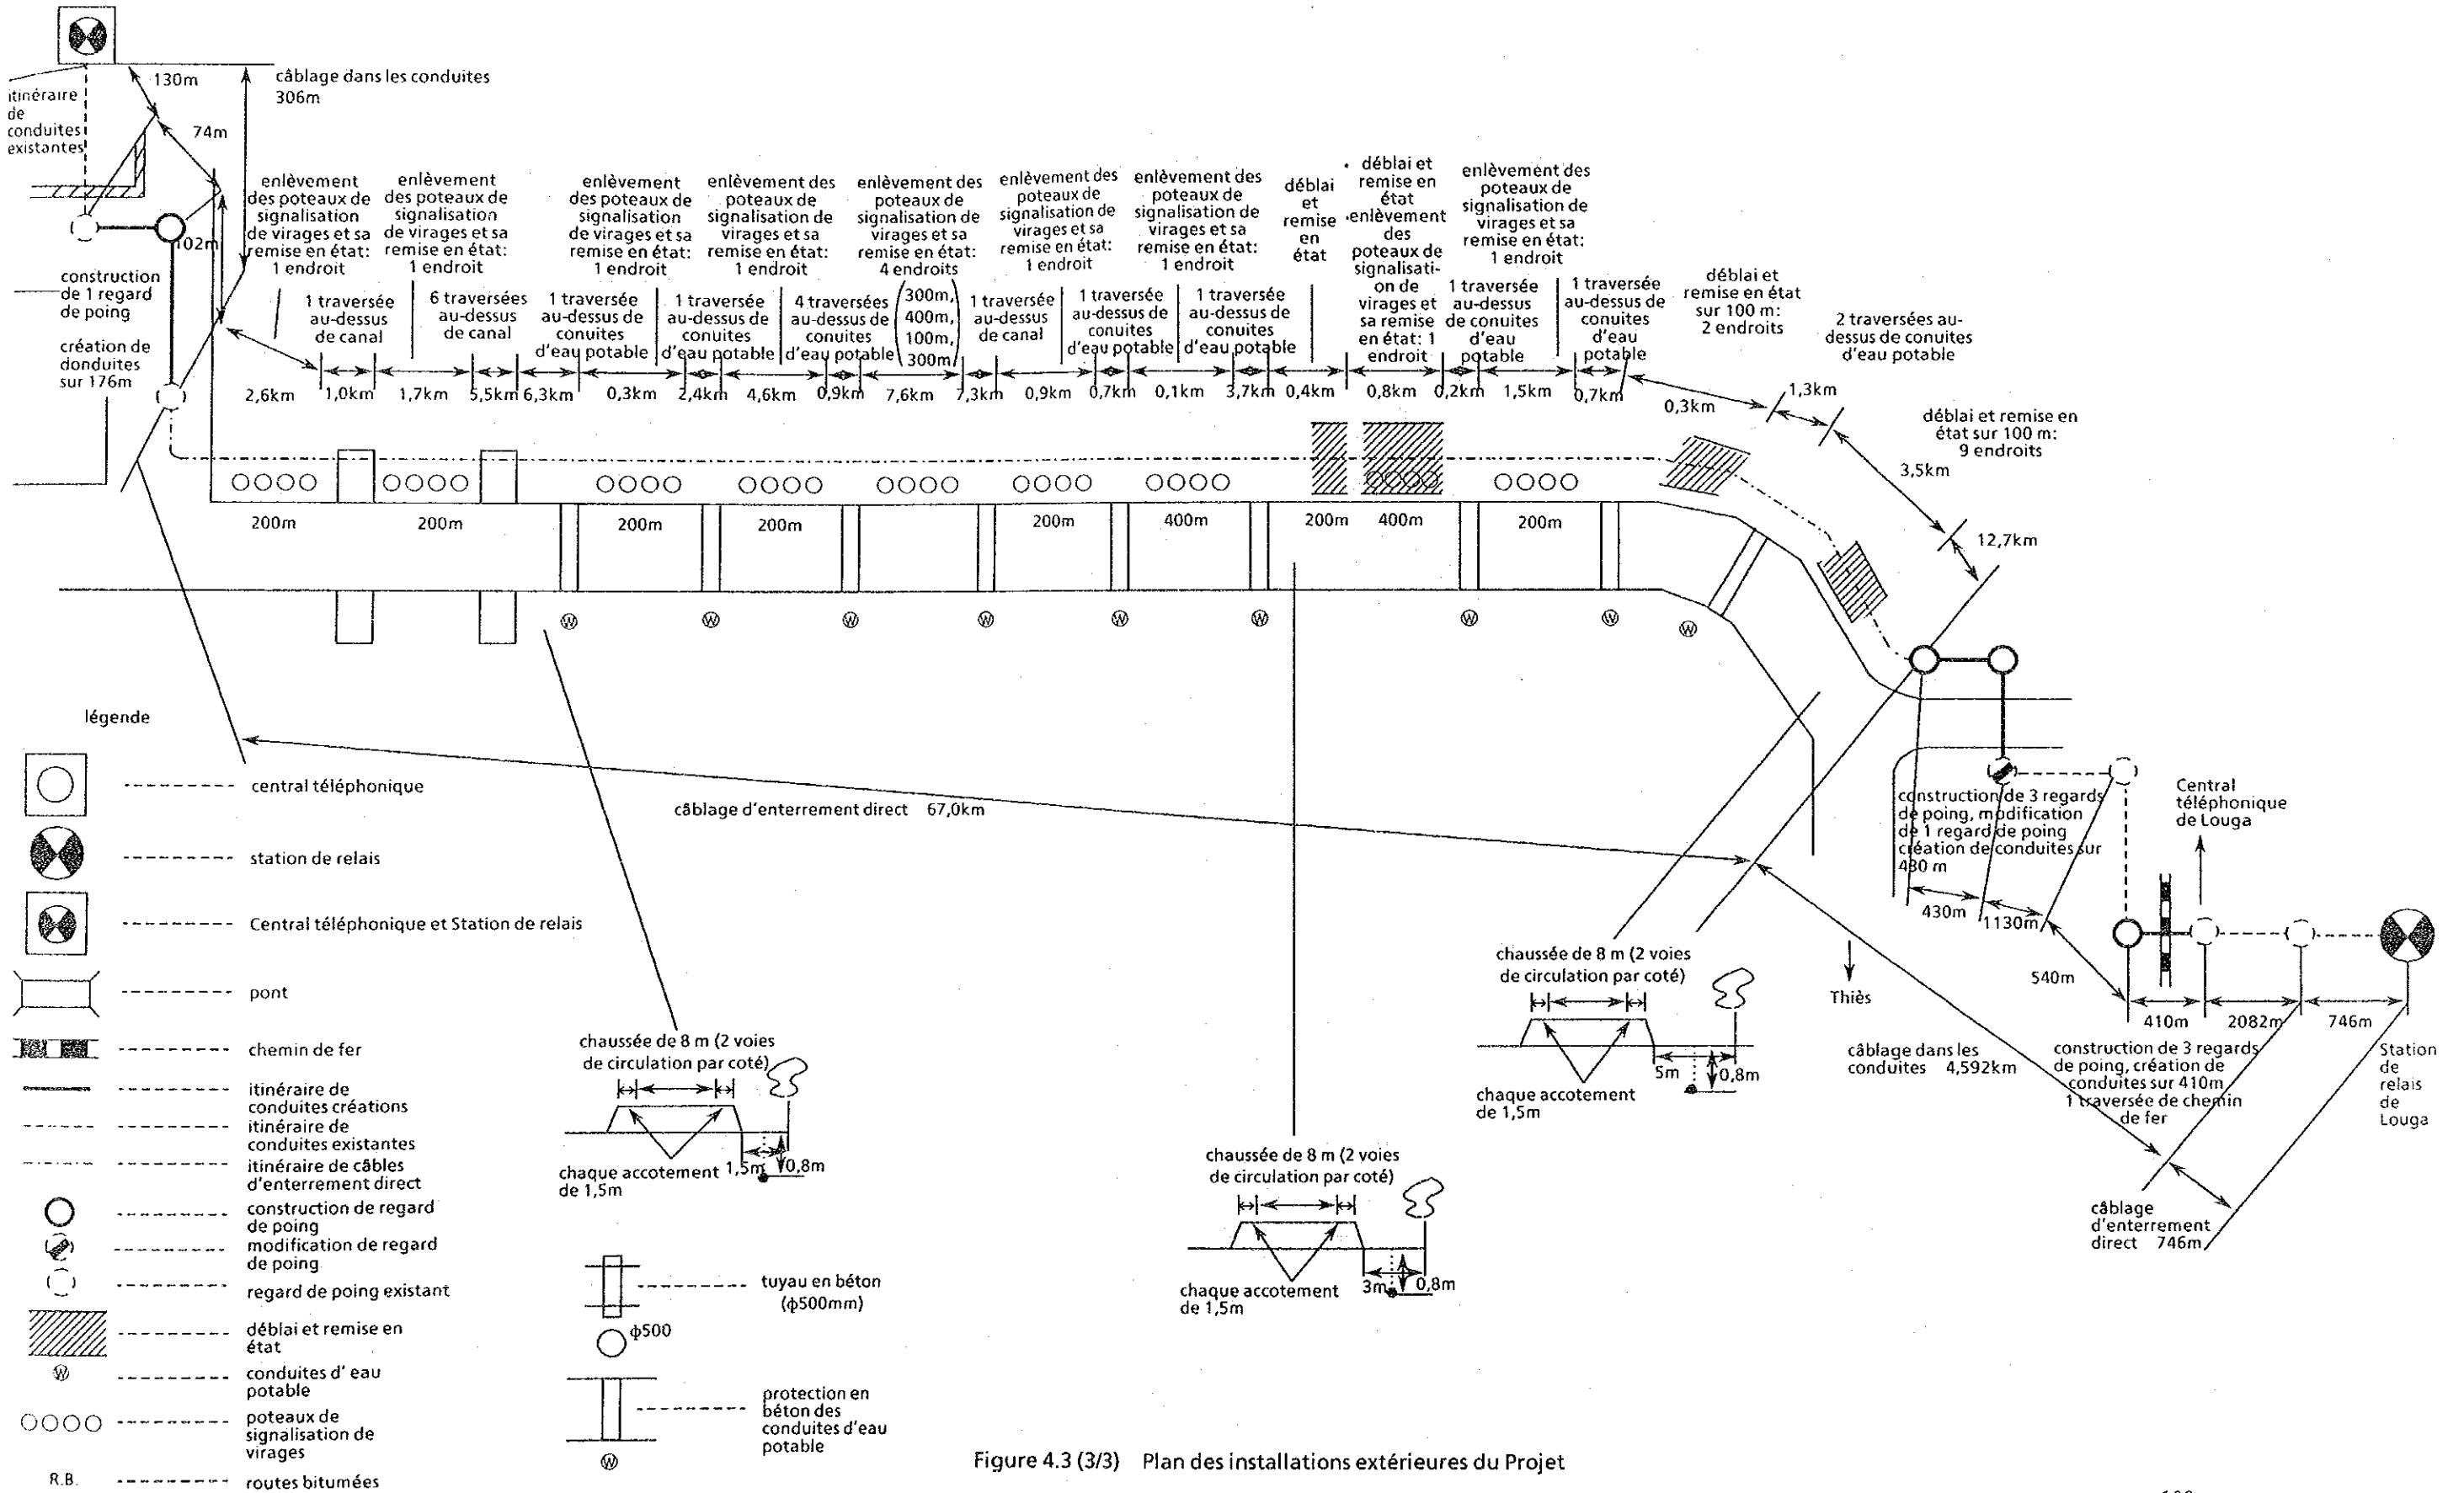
(3/3) Plan des installations extérieures du Projet
